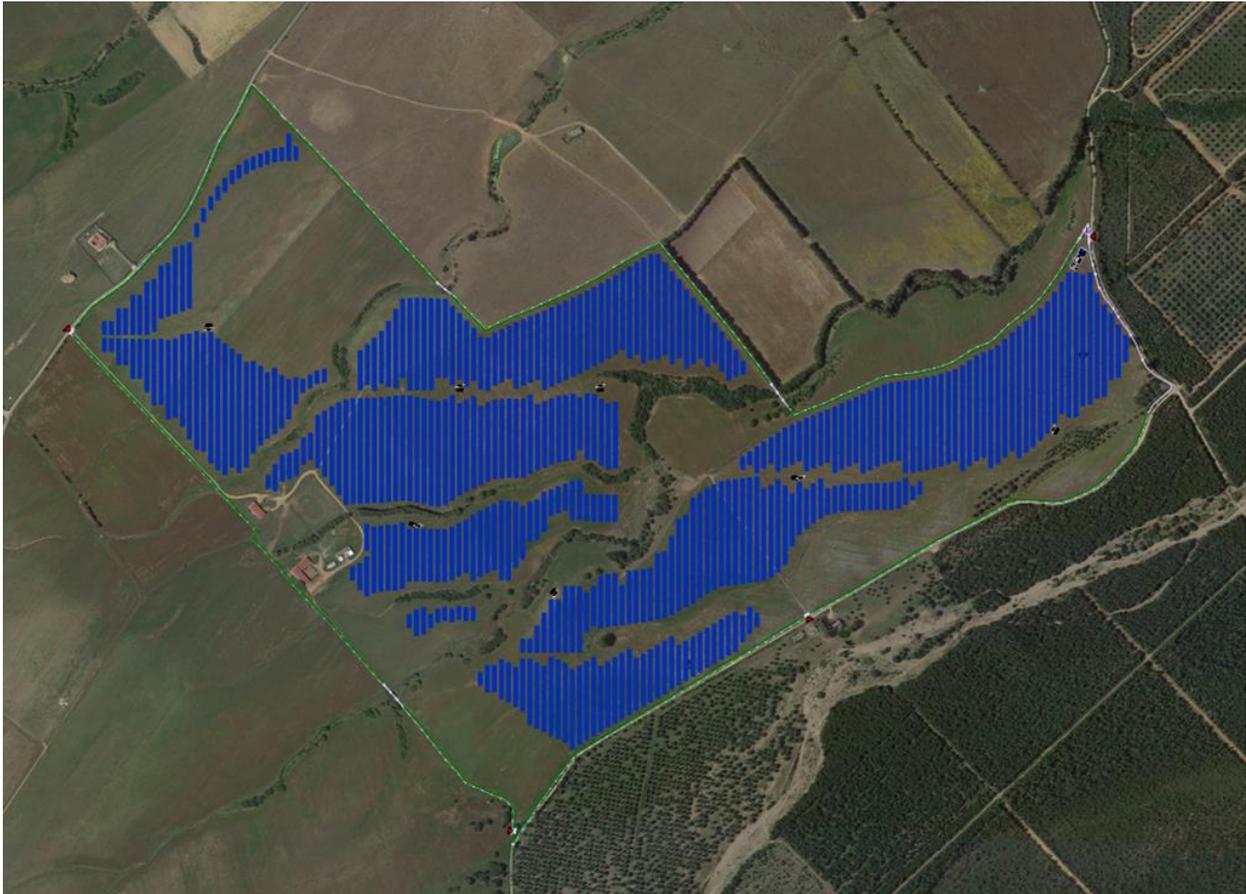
Planimetria dell'impianto fotovoltaico in progetto
